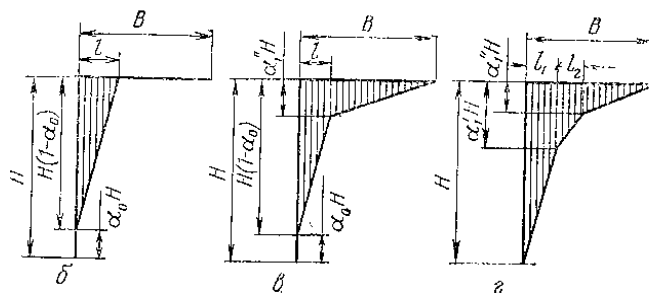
К расчету напряжений в бетонных гравитационных плотинах:
